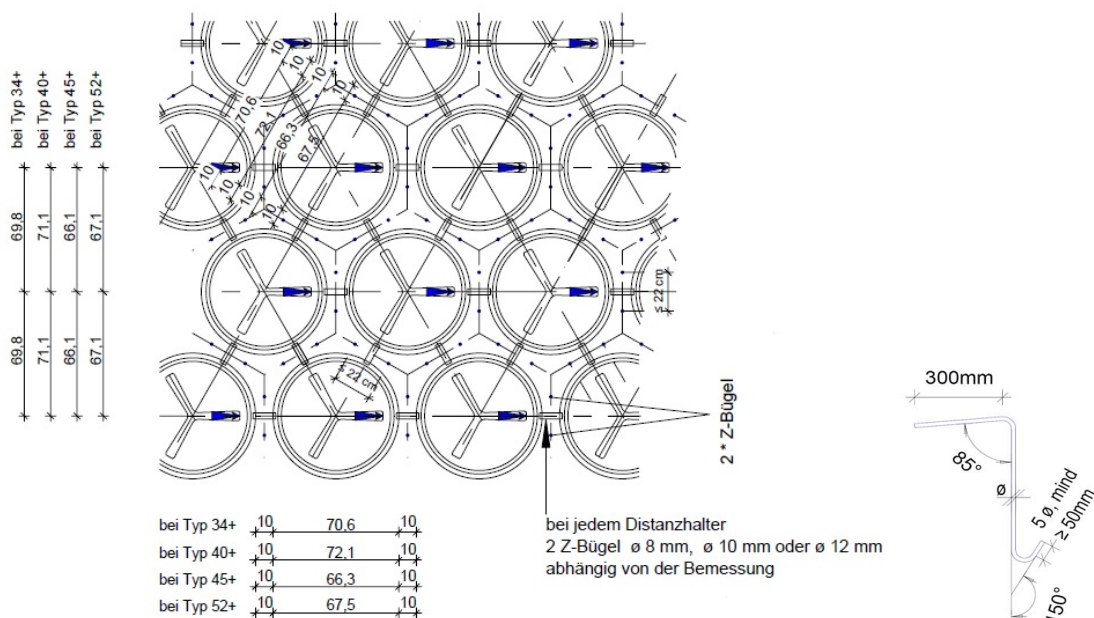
Deckenschnitt mit Einbaulage der Querkraftzulagen (Einbau erfolgt rechtwinklig zur Bauteilachse bzw. zur Deckenebene, die Querkraftzulagen sind über die ganze Querschnittshöhe der Decke - unter Berücksichtigung der Betondeckung - zu führen)
